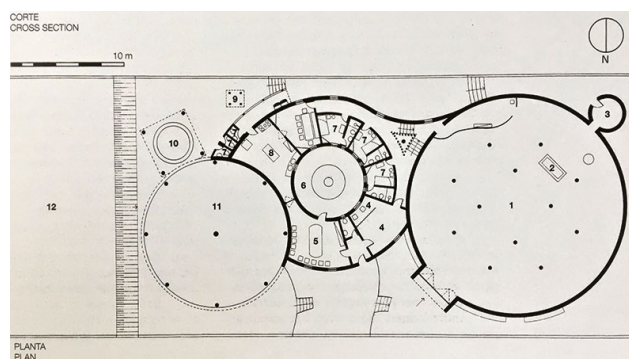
Igreja do Divino Espírito Santo, de Lina Bo Bardi, planta baixa de projeto (1978). Da esquerda para a direita: barracão, claustro e nave.¹³⁶
